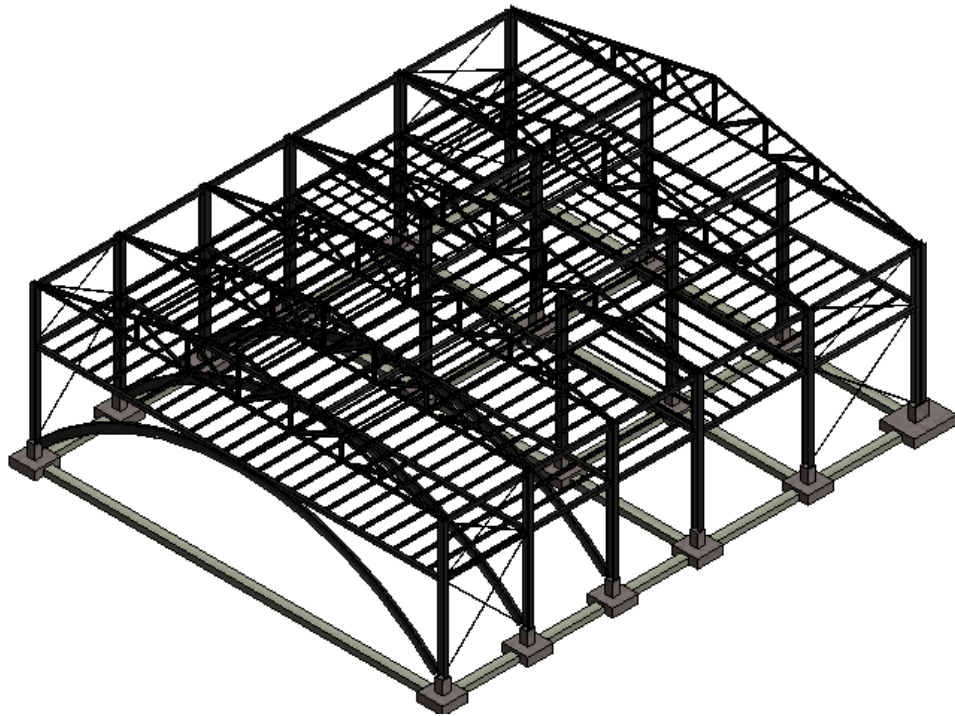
Estructura de la zona de oficinas incorporando las vigas de tornapunta.
